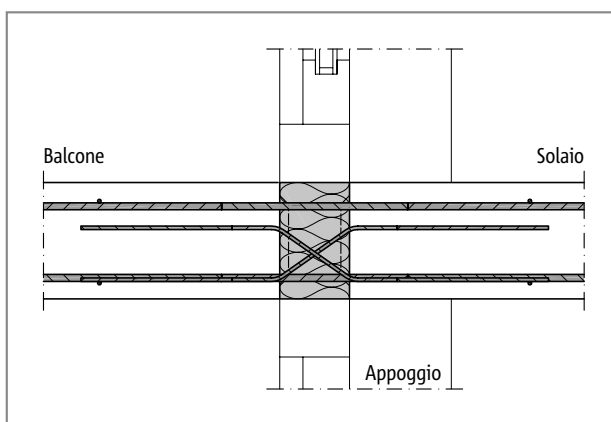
Schöck Isokorb® tipo DXT: sezione costruttiva; solaio piano
